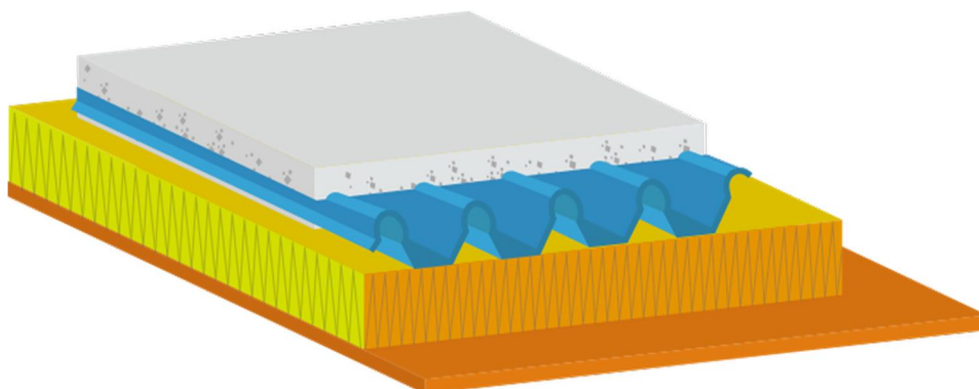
dalle mixte avec plafond coupe feu+isolation
